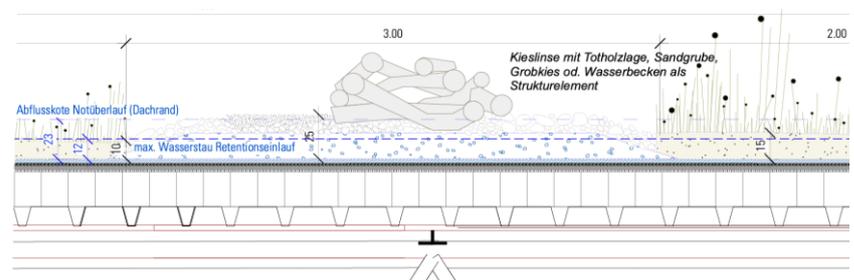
Strukturelemente (Ausschnitt Plan DETAILS UND AUFBAU BEGRÜNUNG SOLARDACH KOE-R720-01)
